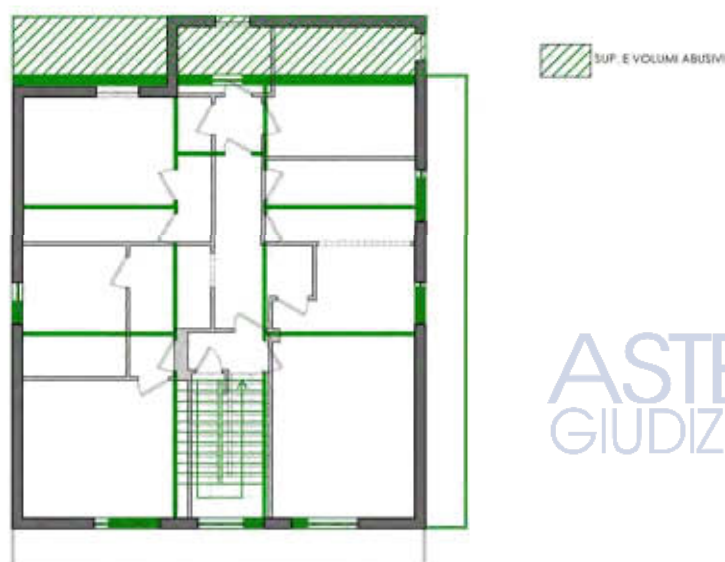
Sovrapposizione planimetria progetto approvato (in verde) su rilievo stato di fatto _ Lotto 1
